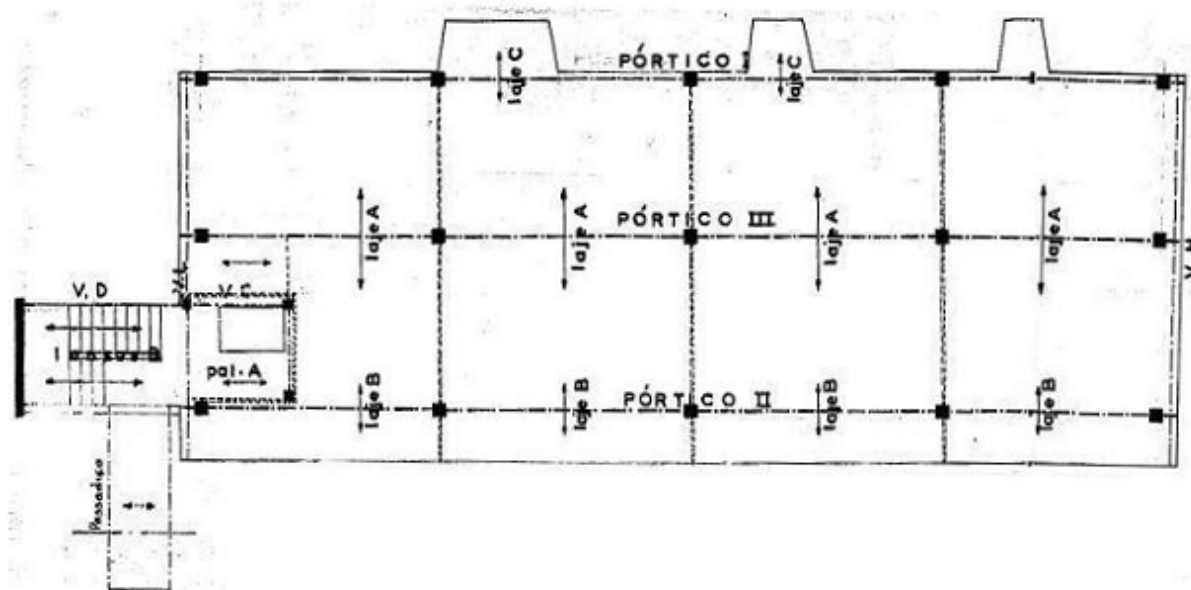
Disposição em planta dos pórticos ao nível do piso 1 (adaptado de Milheiro, 2008)
